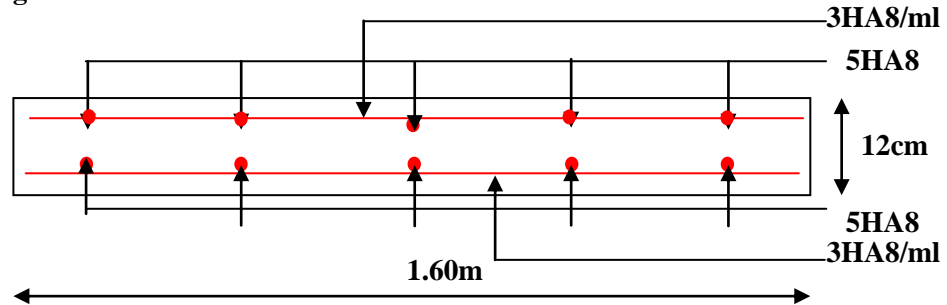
Schéma de ferrailage de la dalle pleine D4
